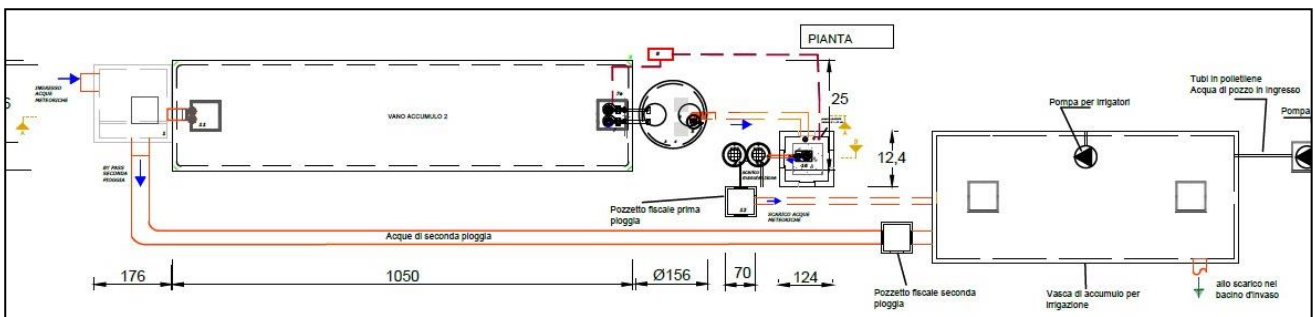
Planimetria dell'impianto di depurazione – Tavola 7
